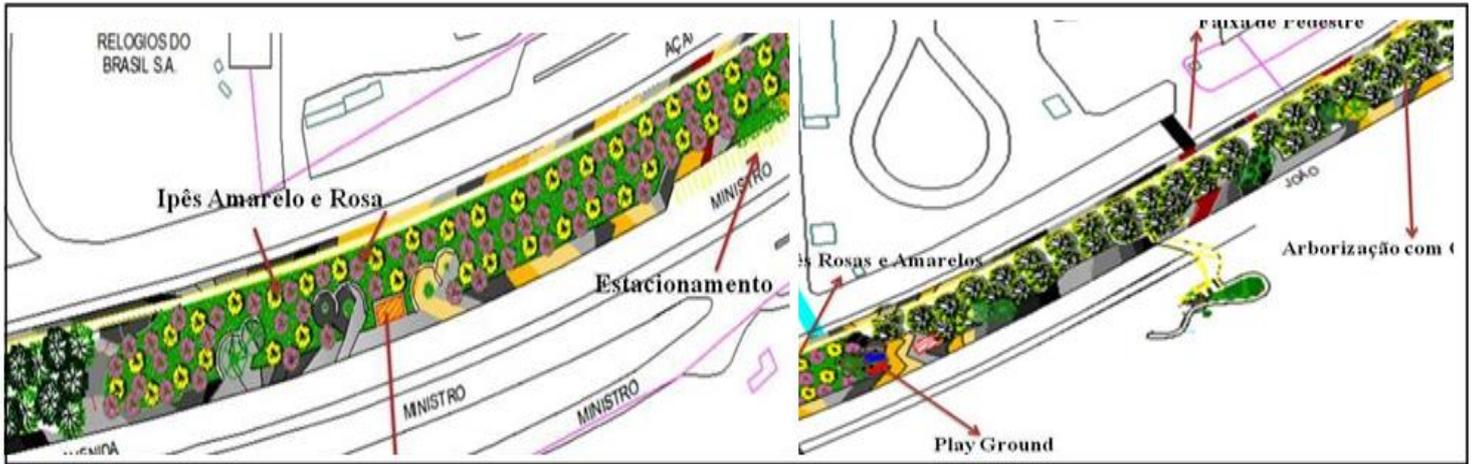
Planta de layout da 3ª e 4ª parte do Calçadão da SUFRAMA.
